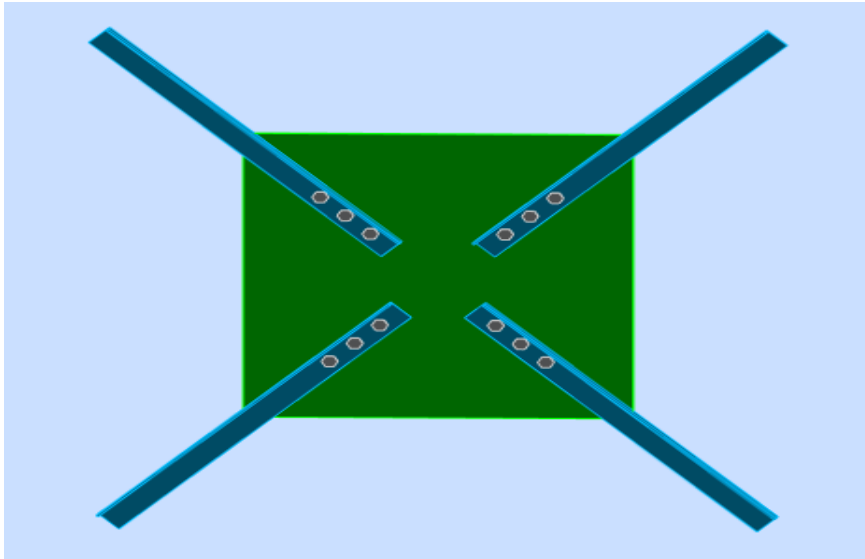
10 : Assemblage des diagonales de la poutre au vent.
